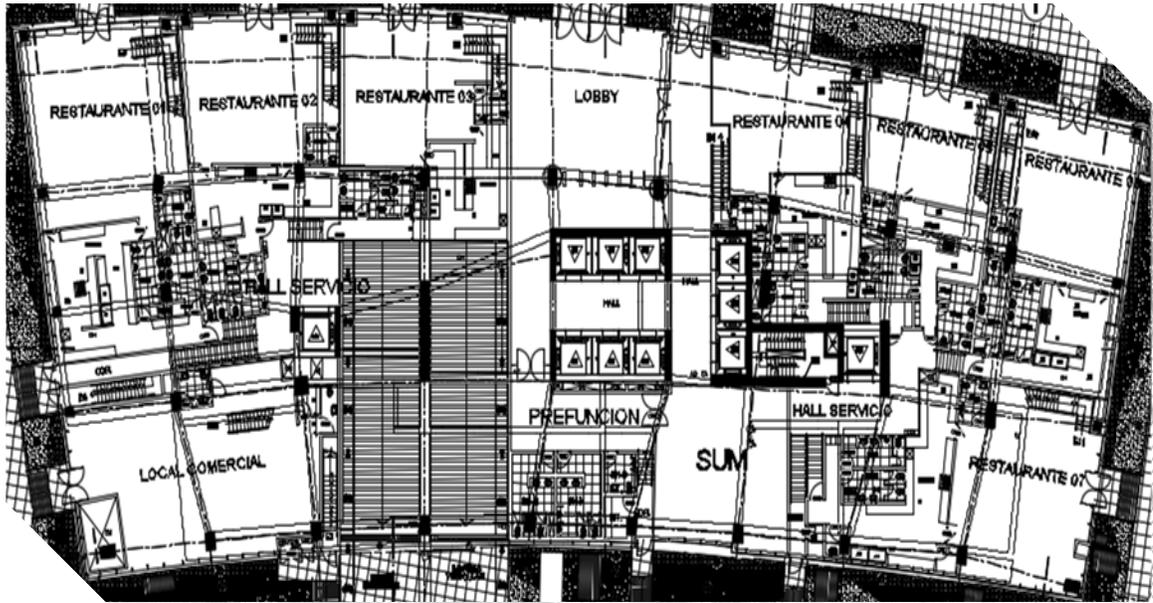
Plano de arquitectura del primer piso – Edificio Anexo Torre 3
